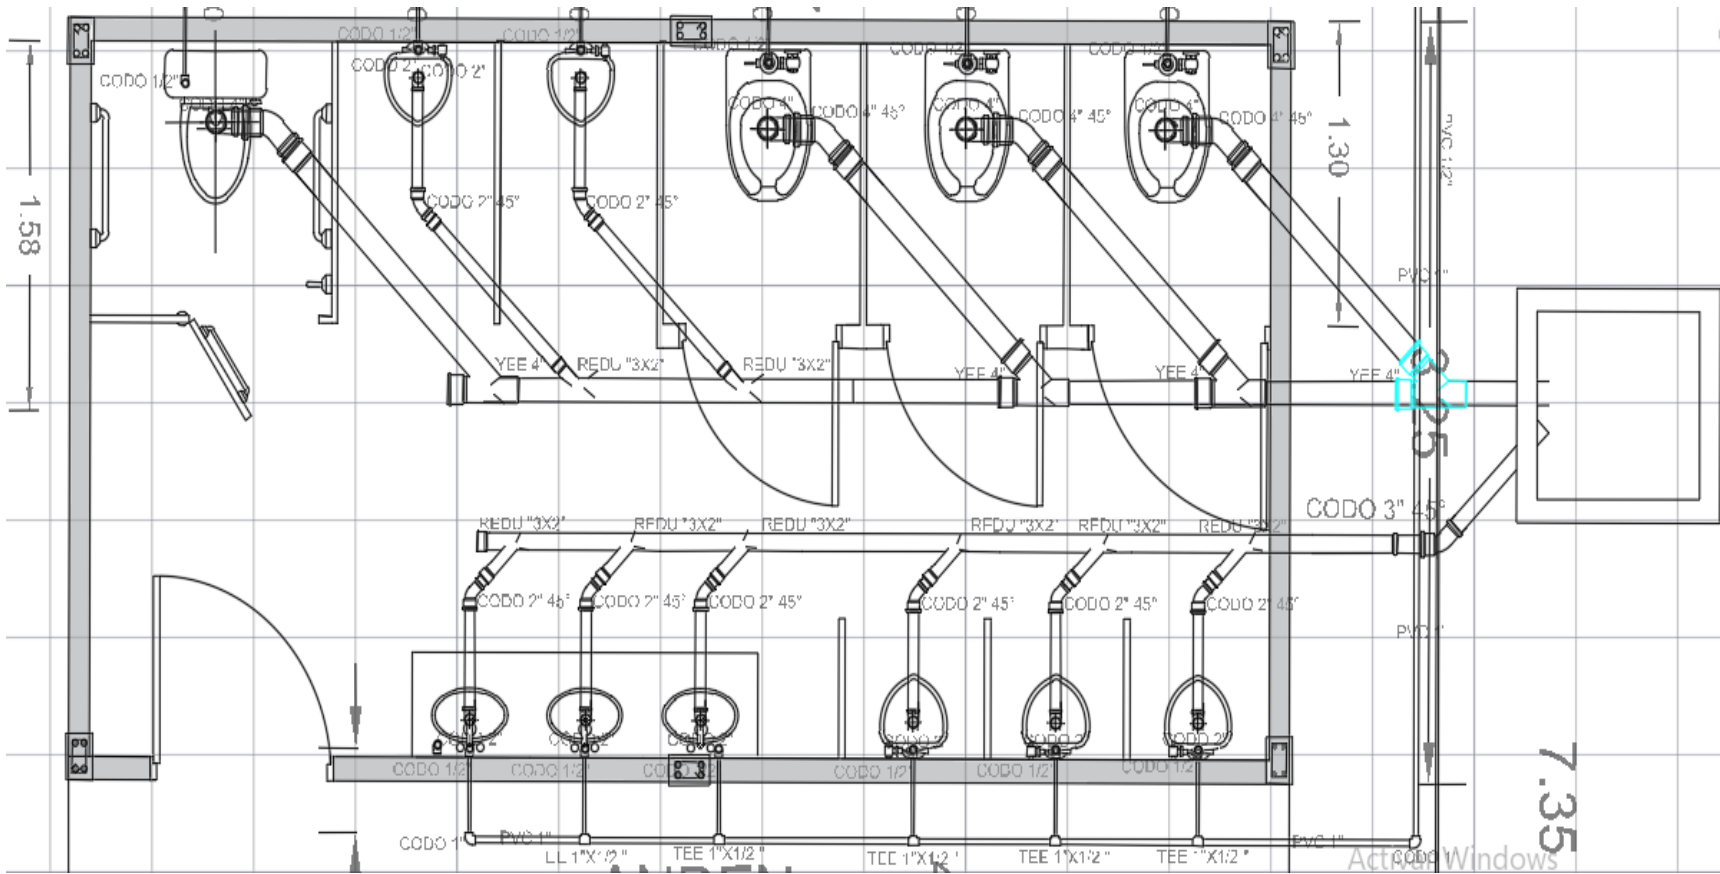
Plano hidrosanitario para construcción de unidad sanitaria en el colegio Junín. Fuente: Practicante (2019).
